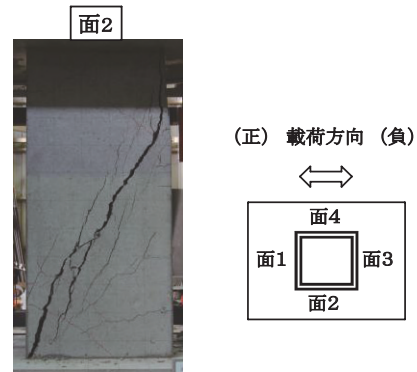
荷重終了後のひび割れ状況 (No.1)
